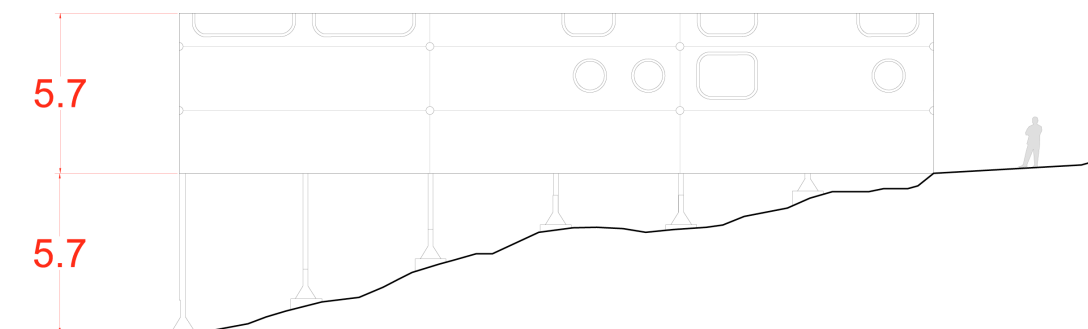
Alzado. Zip-Up House (1968). Richard Rogers.
